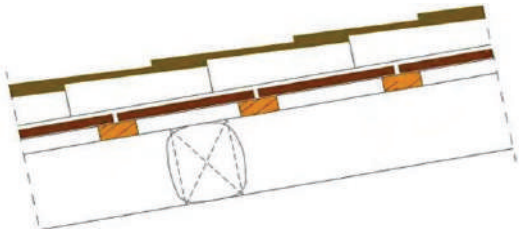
Secció tipus de l'estructura dels sostres de la planta primera.
